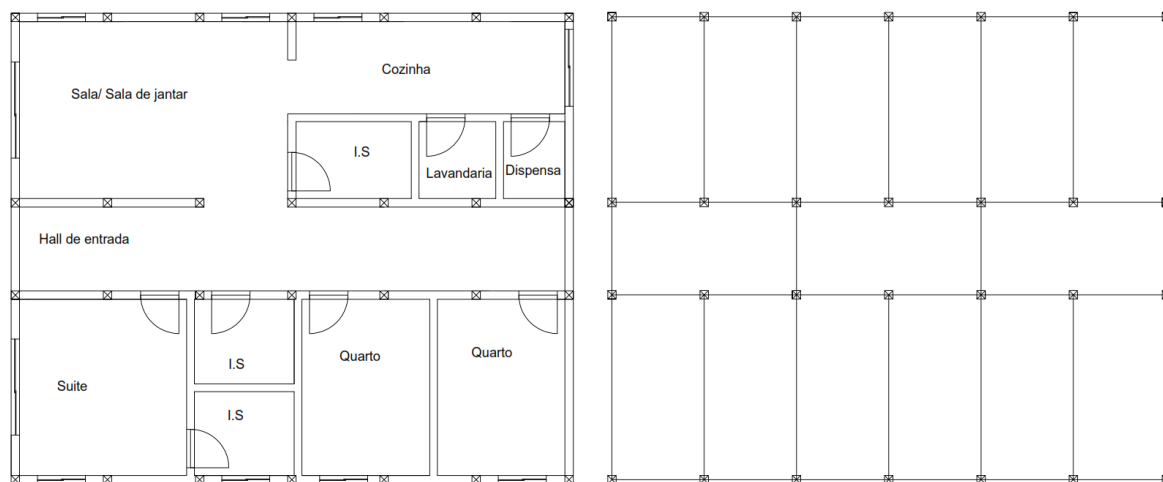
Planta de arquitetura e Planta estrutural, Solução 1, rés-do-chão
